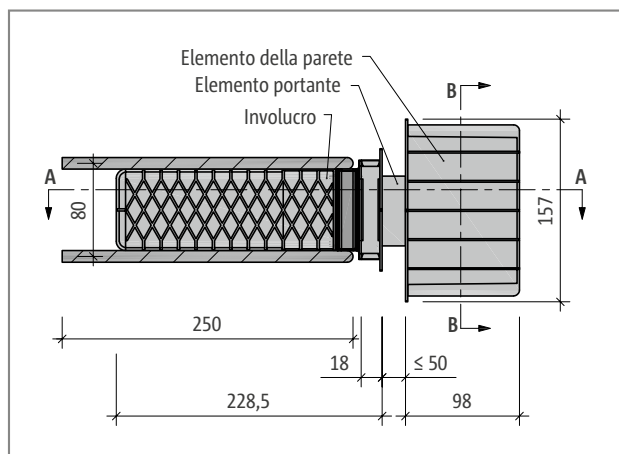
Schöck Tronsole® tipo Q, pianta del prodotto
